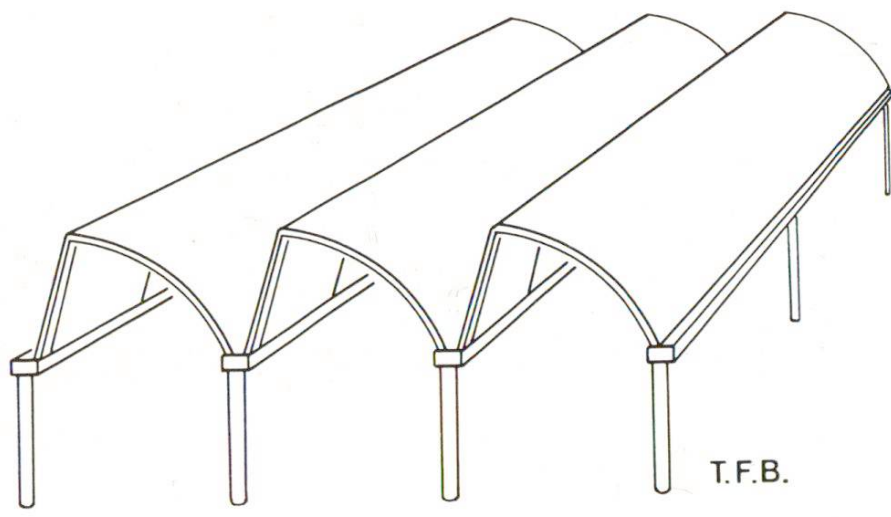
Construction en sheds avec dalle cylindrique de 6 cm d'épaisseur. Dans des constructions plus récentes de ce même type, les bords inférieurs des dalles sont précontraints
